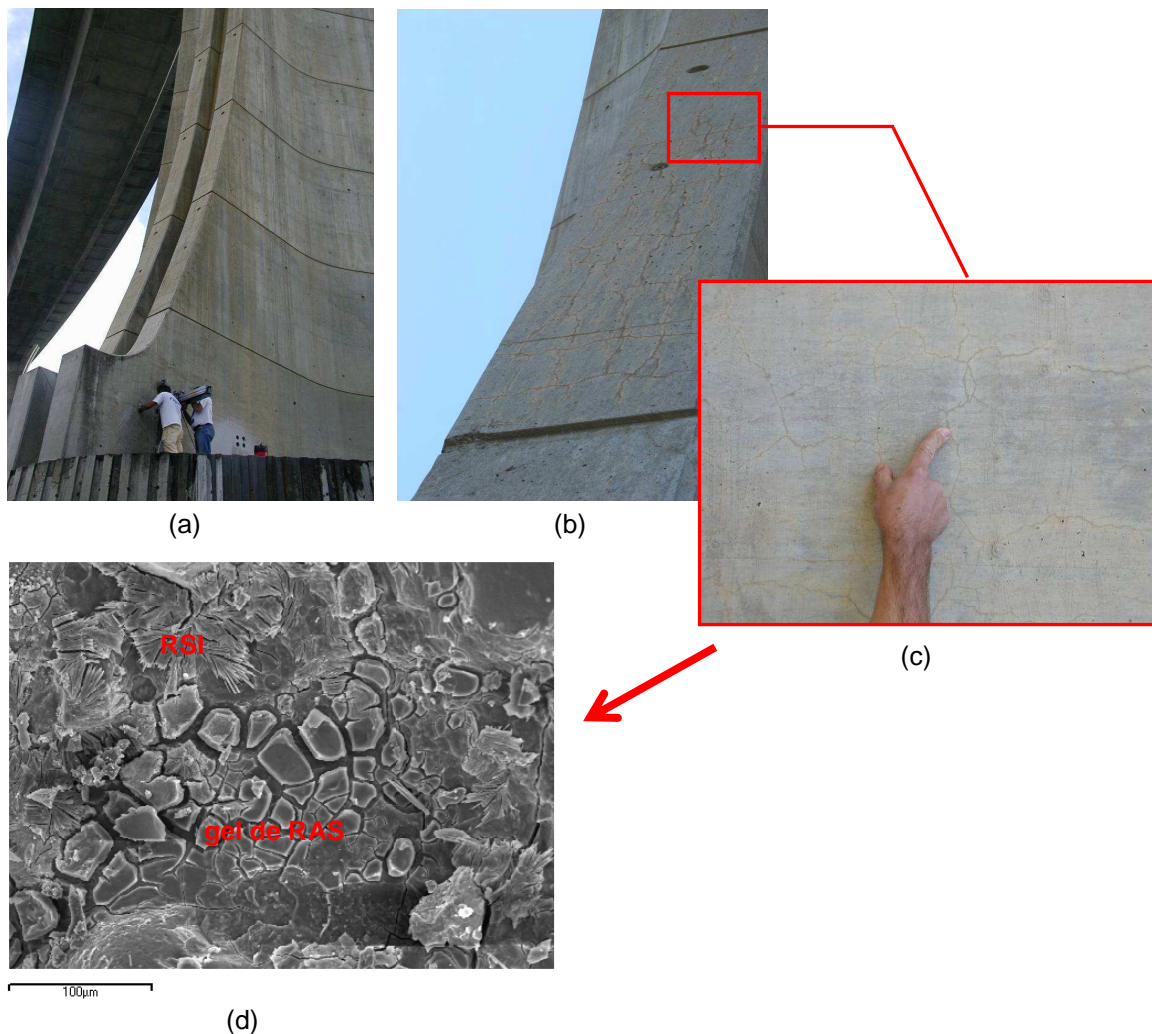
(a) Extracção de carotes num pilar em zonas com e sem fissuração do betão; (b) zona do pilar com fissuração evidenciada; (c) pormenor da fissuração nas nervuras do pilar; (d) identificação de gel de RAS e DEF na zona fissurada.
